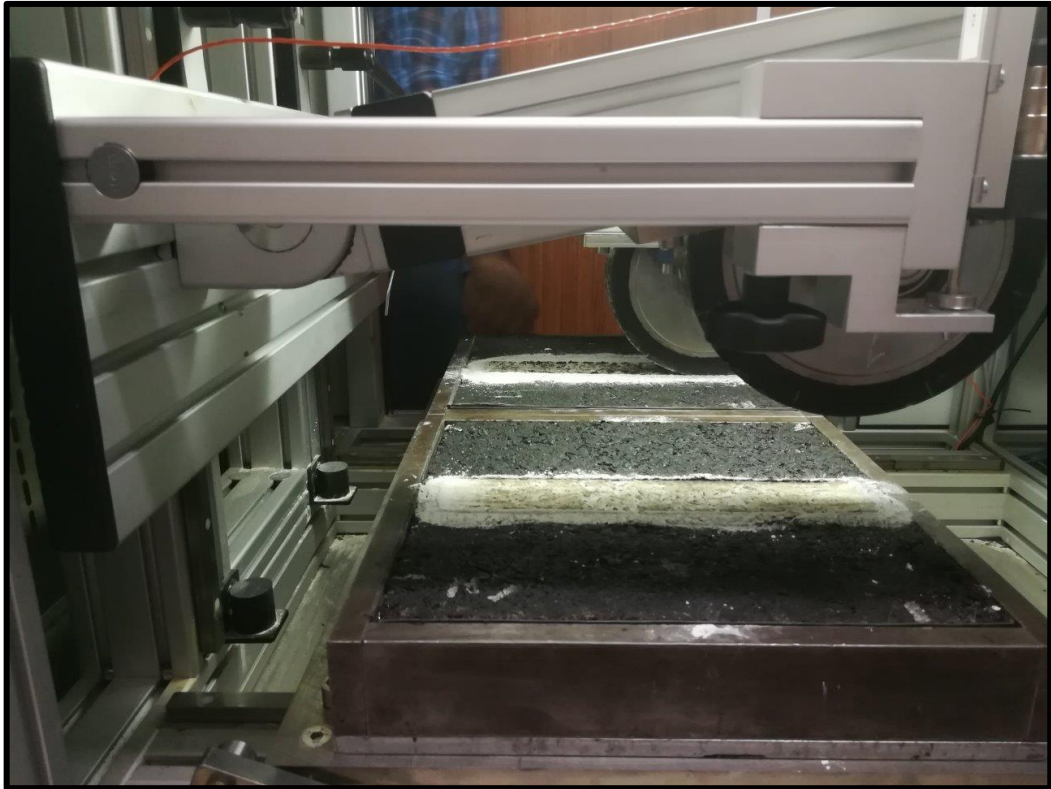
Lajetas para ensaio de Wheel Tracking (1)
